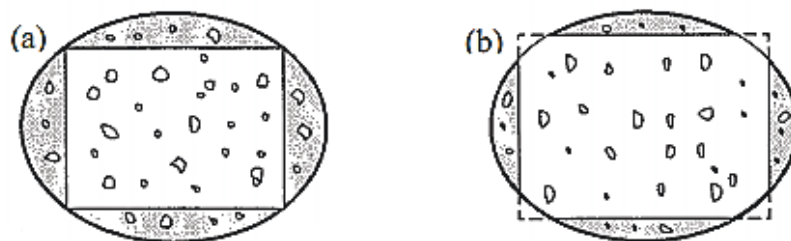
Modification de forme d'un poteau à section rectangulaire. (Teng et al 2002)
